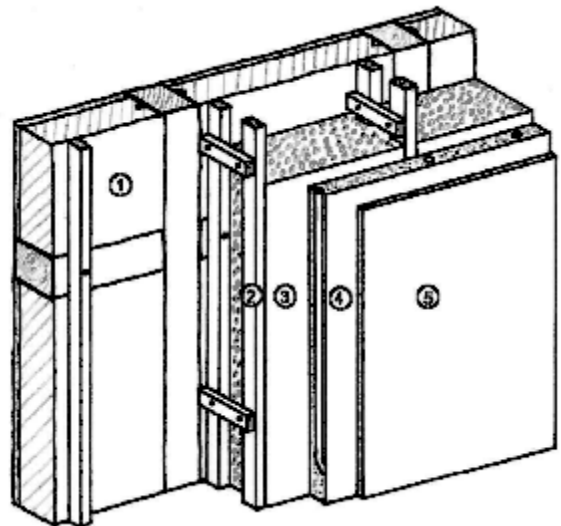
Prinzipieller Aufbau der Wandkonstruktion im Fachwerkteil
